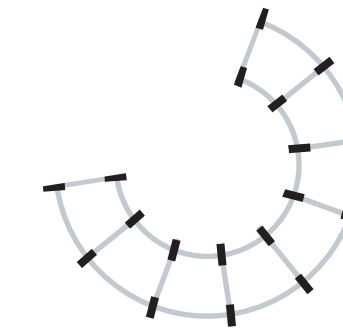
Esquema planta estructuras niveles 3, 4 y 5. Sistema aporticado. Fte.: Elaboración propia
